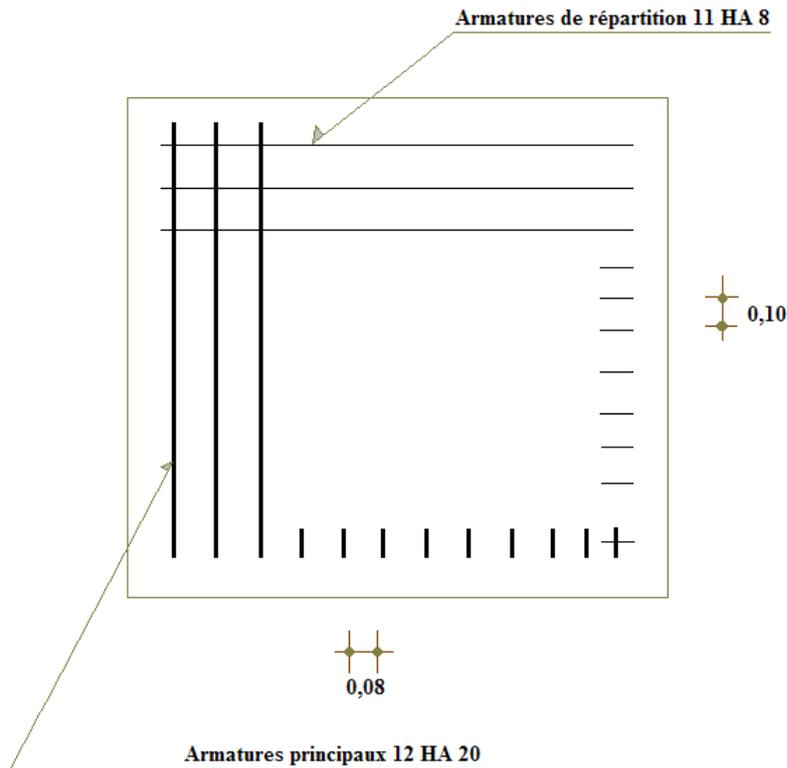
Principe de ferrailage sur 1 m² de la dalle du radier du canal principal
